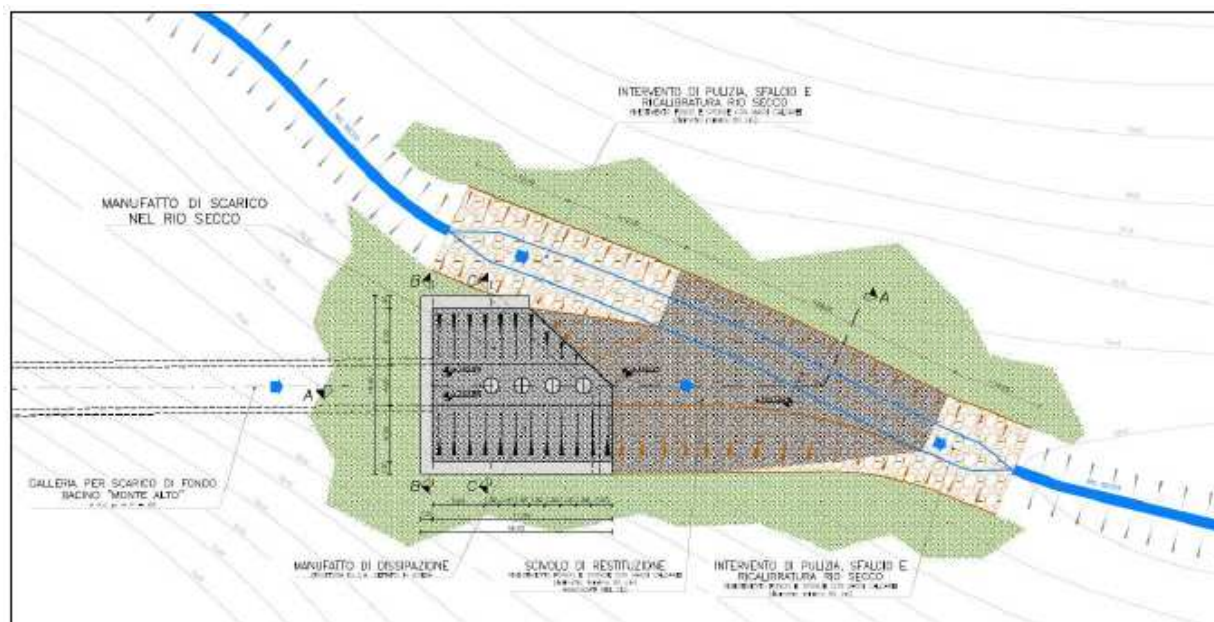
Stralcio planimetrico tracciato galleria di collegamento.
